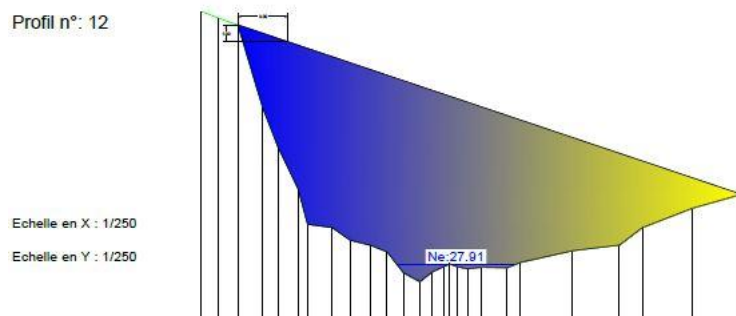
coupe en travers remblaiement profil 12 (proche extrémité aval)
